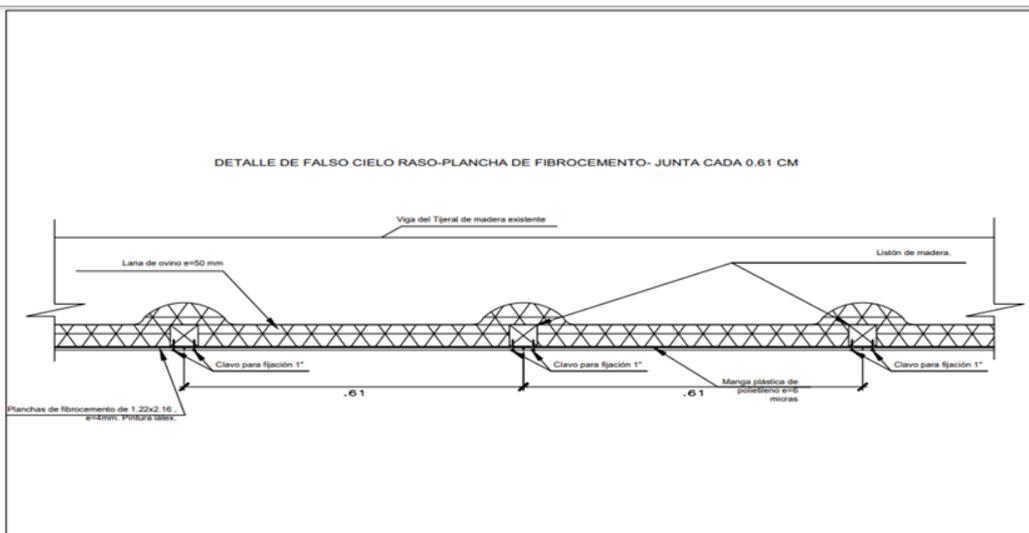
Plano de detalle del falso cielo raso plancha de fibrocemento junta cada 0.61 cm
